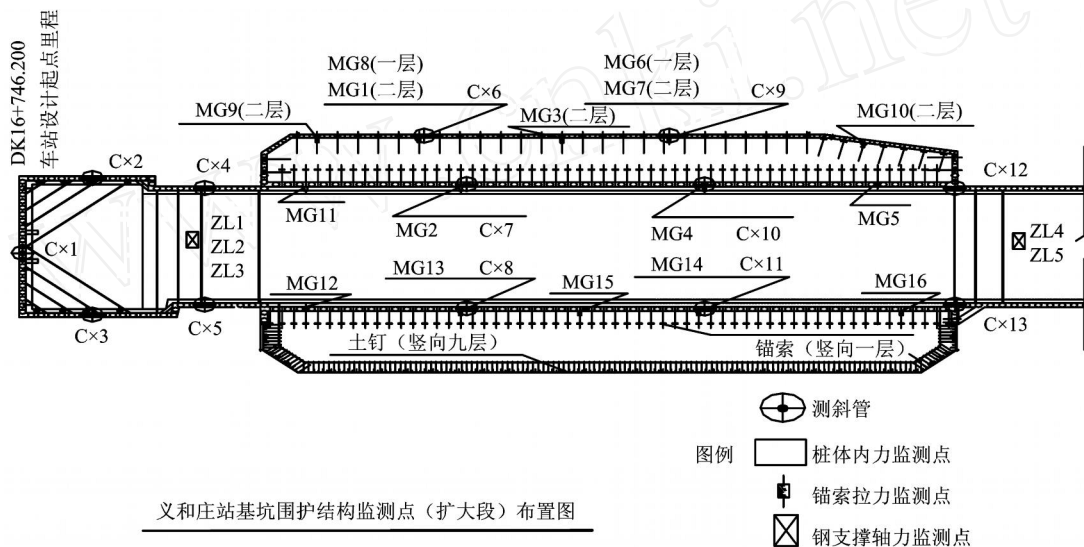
义和庄车站基坑围护结构监测点(扩大段)平面布置图
